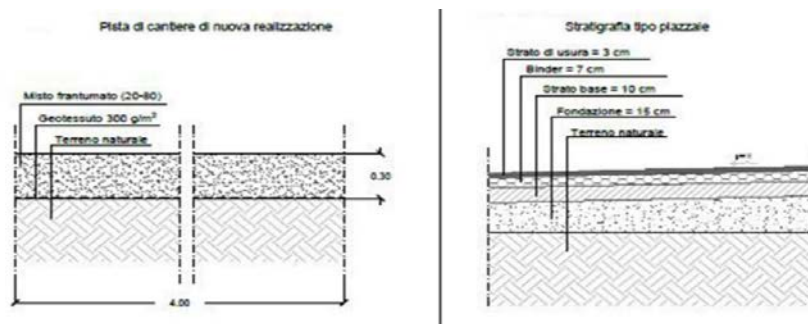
Particolari costruttivi strada di cantiere e piazzale
